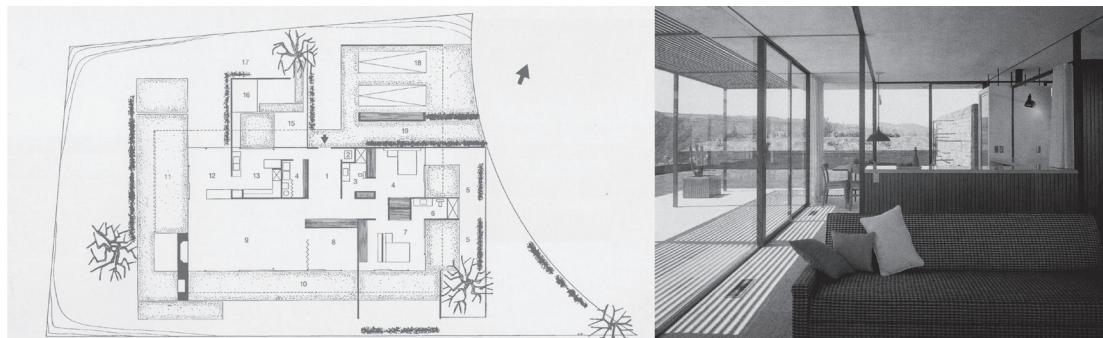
A y 4B. Pierre Koenig, CSH#21, West Hollywood CA., 1958. Planta (izd.) y vista al ingreso (dcha.).
